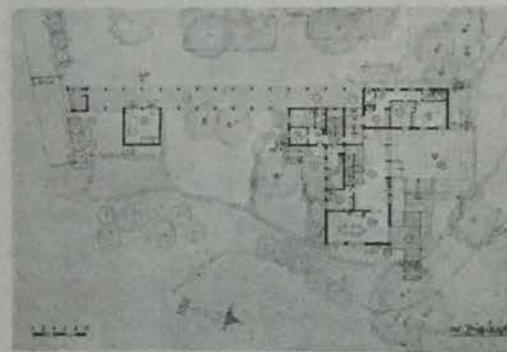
b - Villa Caraccio: pianta del piano terreno.
